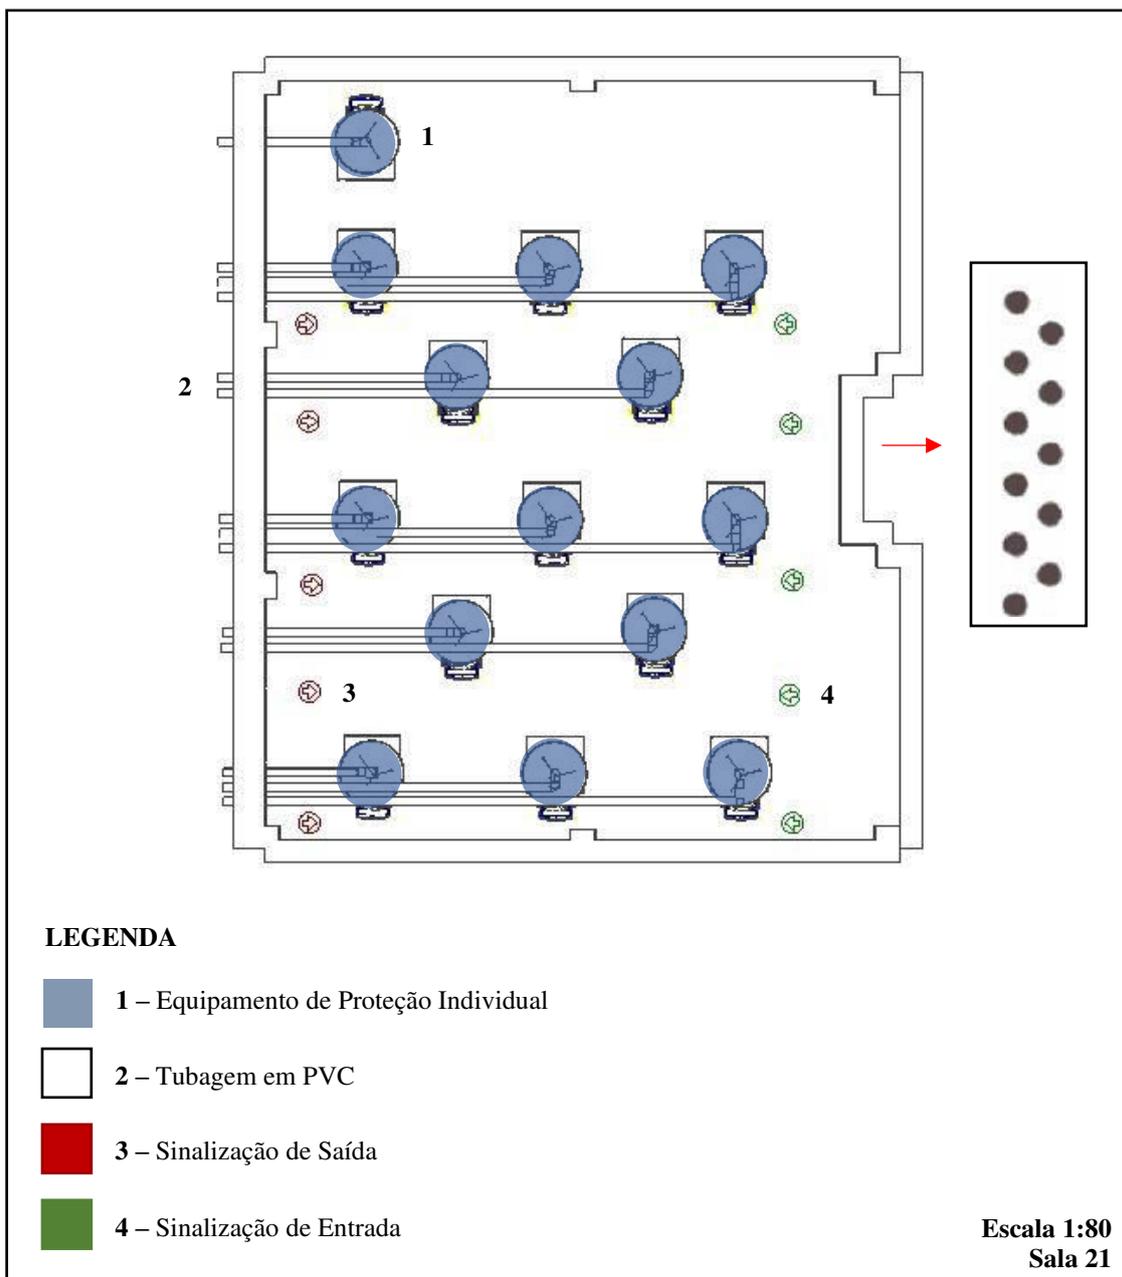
Planta da sala 21 com a disposição dos equipamentos em dupla fronteira
